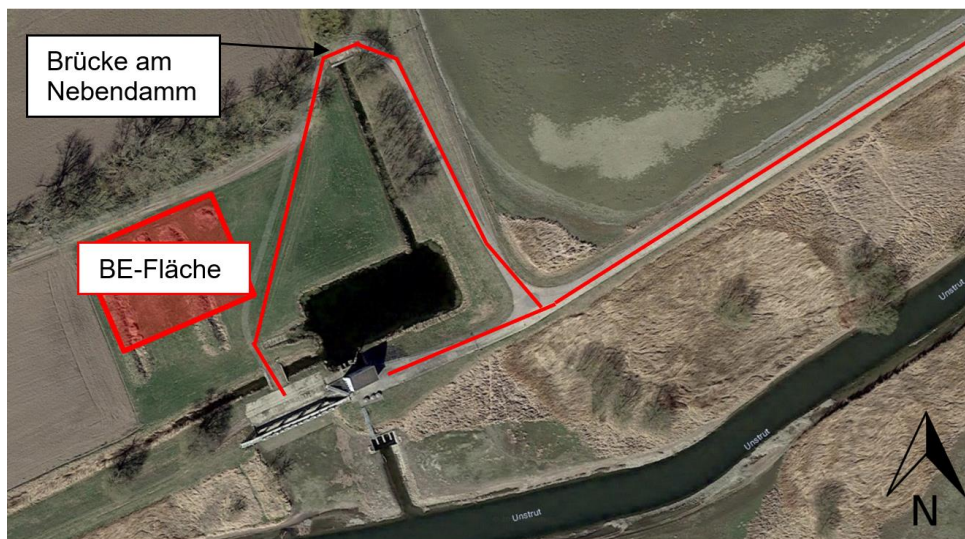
geplante Baustellenzufahrt und BE-Fläche
